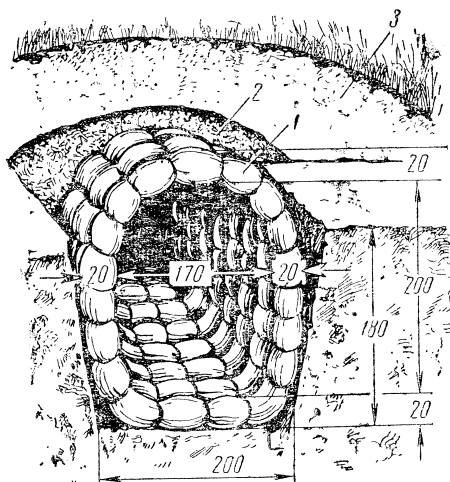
Укрытие в песчаных грунтах из хворостяных кольцевых фашии:
